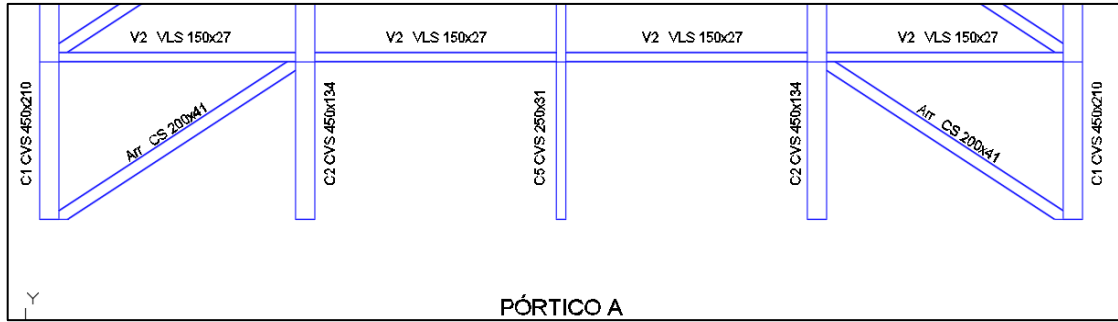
Detalle de acero estructural en pórtico principal de estructura de acero
